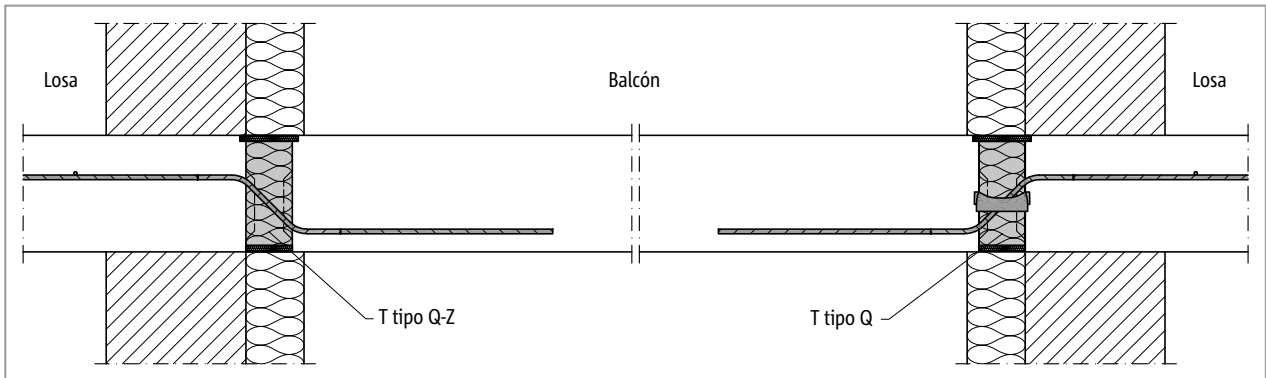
Schöck Isokorb® T tipo Q-Z, Q: Caso de aplicación, losa de hormigón armado tensada sobre un eje
